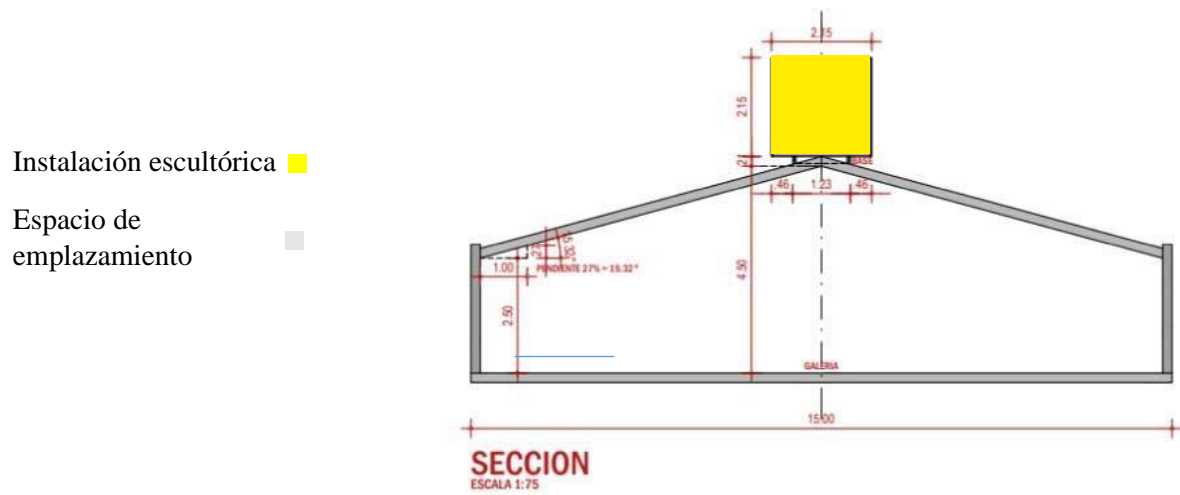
Plano del espacio donde se implanta la instalación escultórica.
